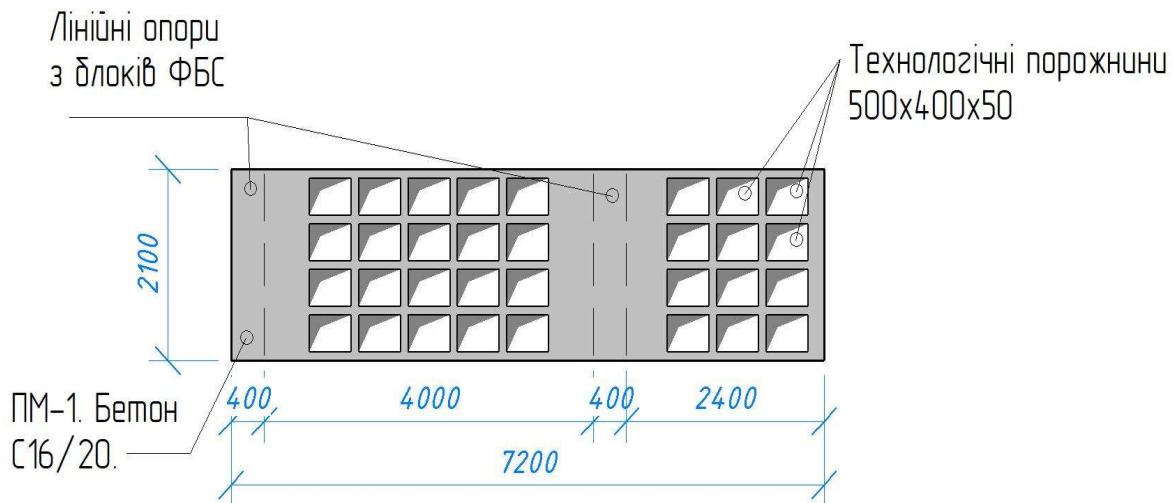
Опалубочне креслення багатопорожнистої плити перекриття.
